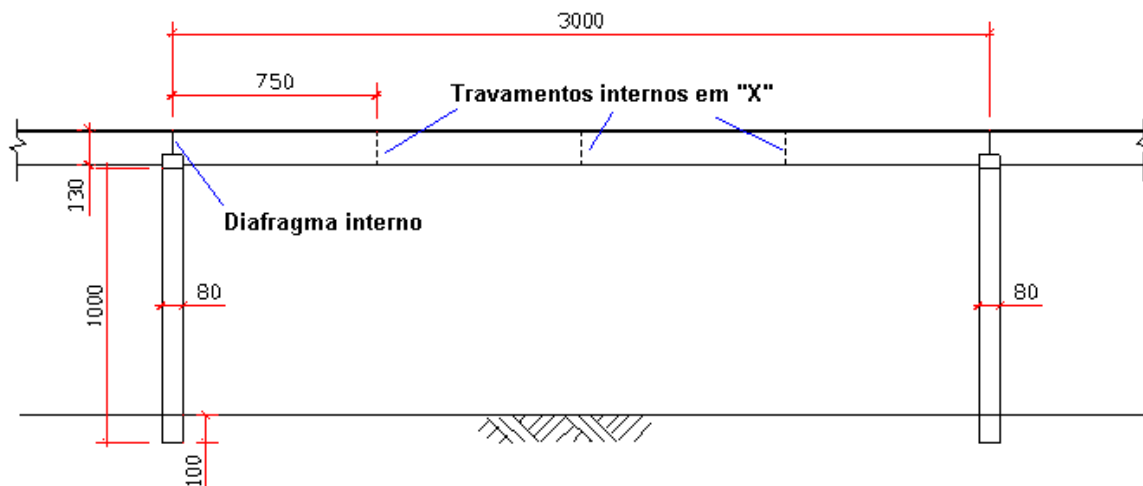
Desenho estrutural: vão das vigas e altura dos pilares (dimensões em cm.)
